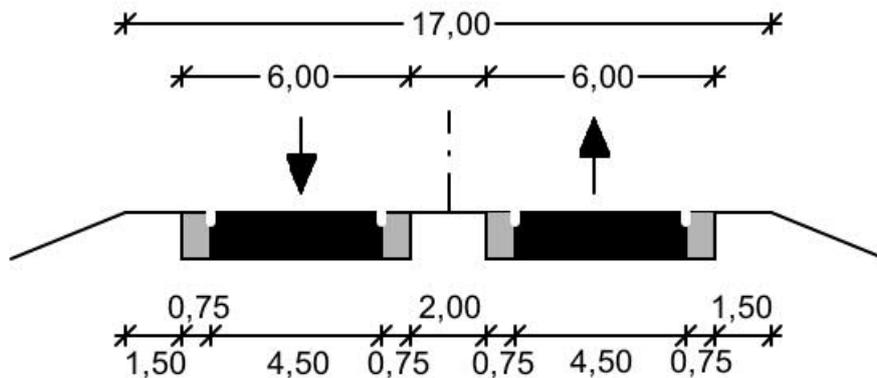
Regelquerschnitt der Verbindungsrampen (nach RAA, Bild 53)
